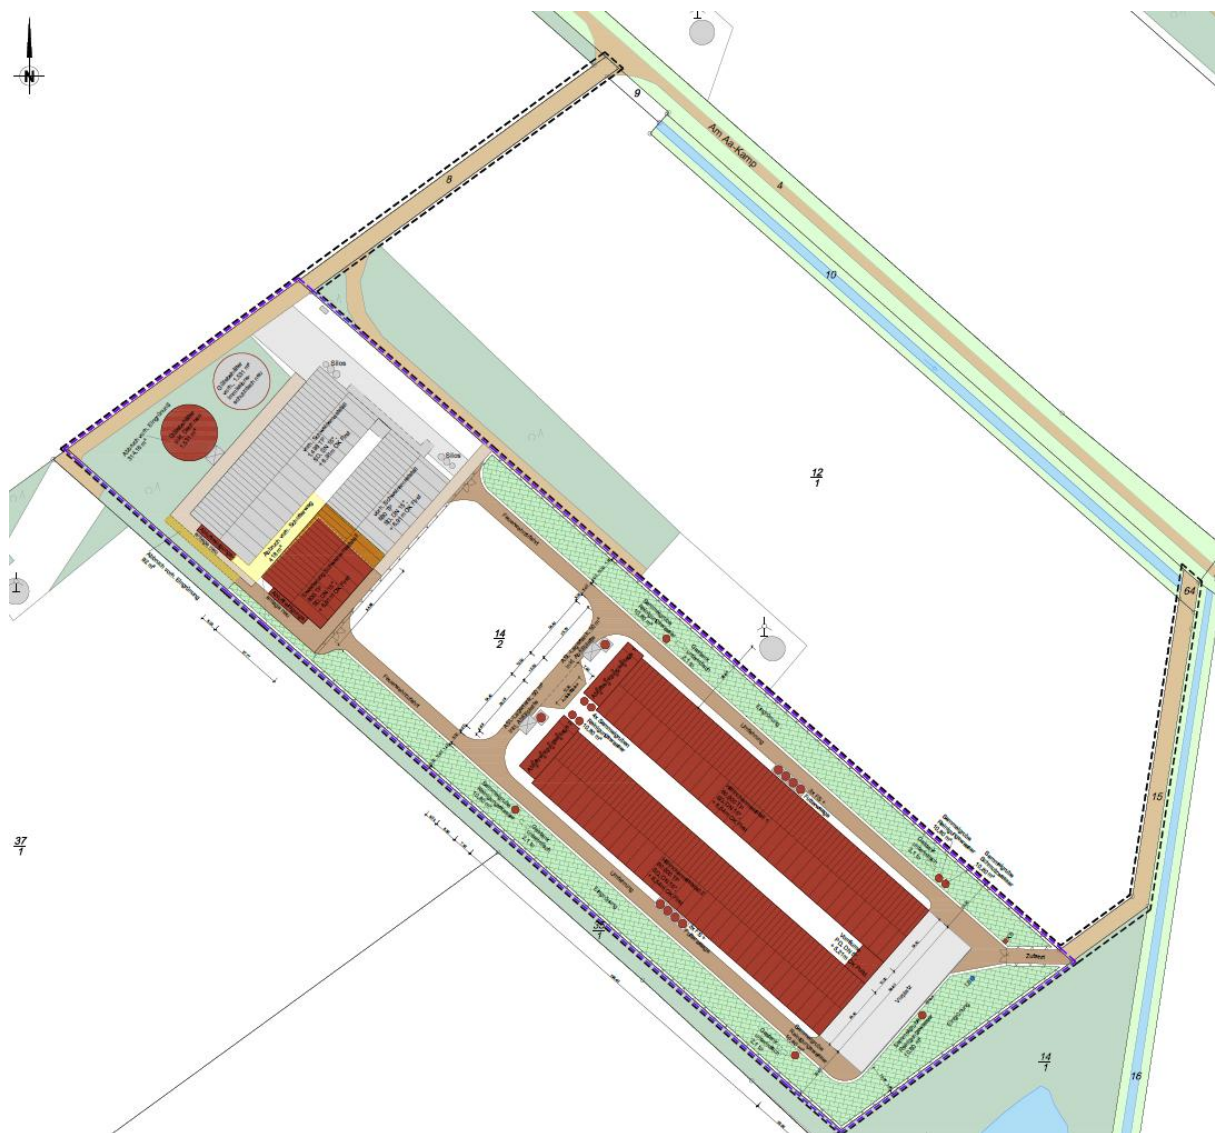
Übersichtslageplan des Vorhabens (Agrar-Planung Emsland GmbH 2025)
